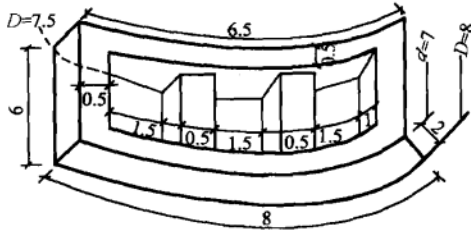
钢筋混凝土复合管片示意图 (单位:m)
